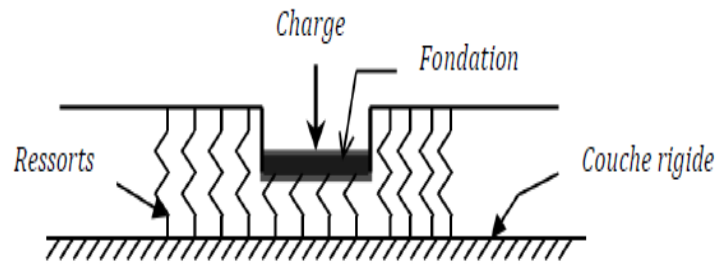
Fondation de Winkler (Dutta, Roy et al. 2002).
